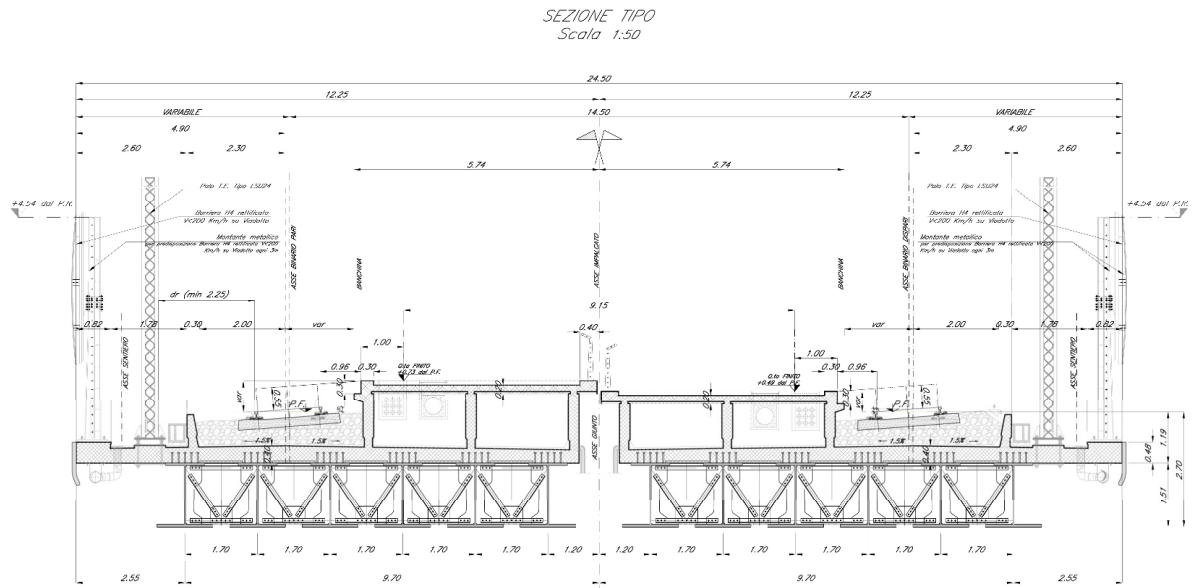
Viadotto Ali: sezione trasversale e prospetto binario pari
